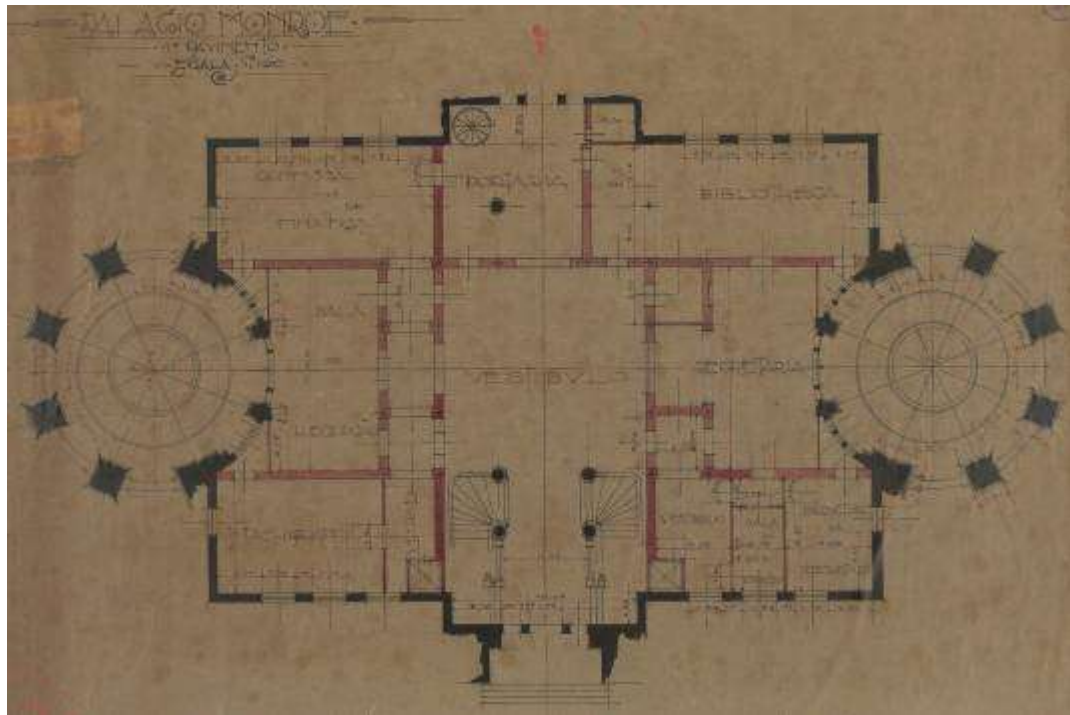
1º Pavimento (Fonte: Arquivo Nacional).
